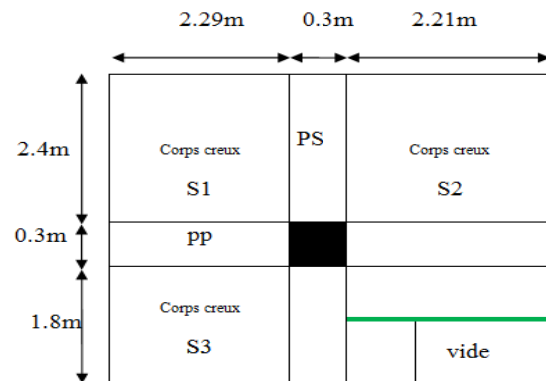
La surface afférente du poteau PB5 (terrasse accessible)
